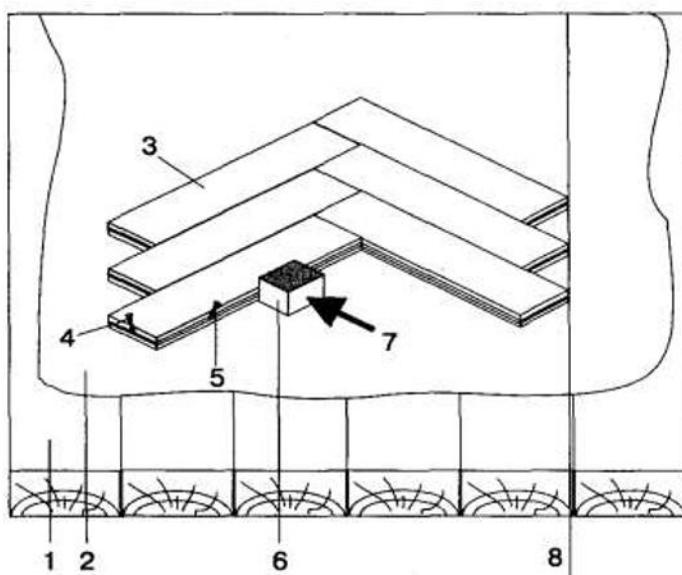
Укладання паркетних клепок на цвяхах 1 – «чорна» підлога; 2 – будівельний папір; 3 - планки; 4 - цвях у торці планки; 5 - цвях з поздовжнього боку планки; 6 - дерев'яна прокладка; 7 – молоток; 8- вісь відпилювання для укладання фризу
